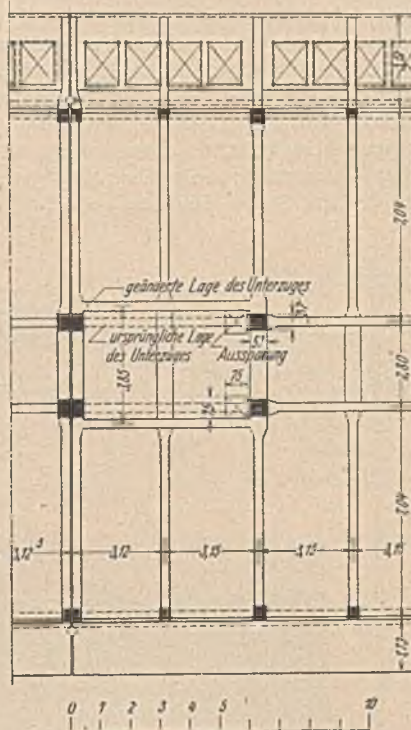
Auswechslung eines Hauptunterzuges über dem Erdgeschoß des Nebengebäudes.
